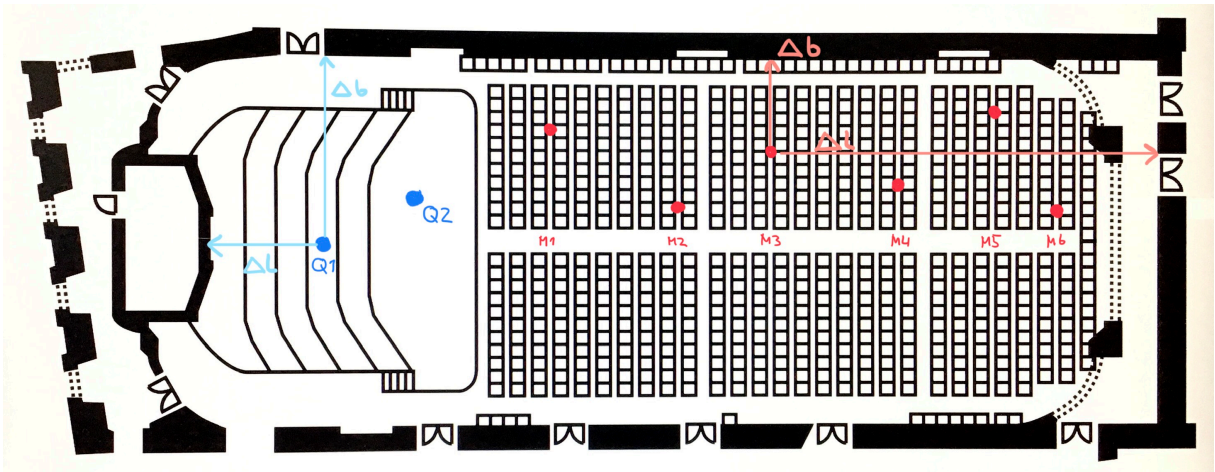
Grundriss mit Quell- und Mikrofonpositionen [3].
